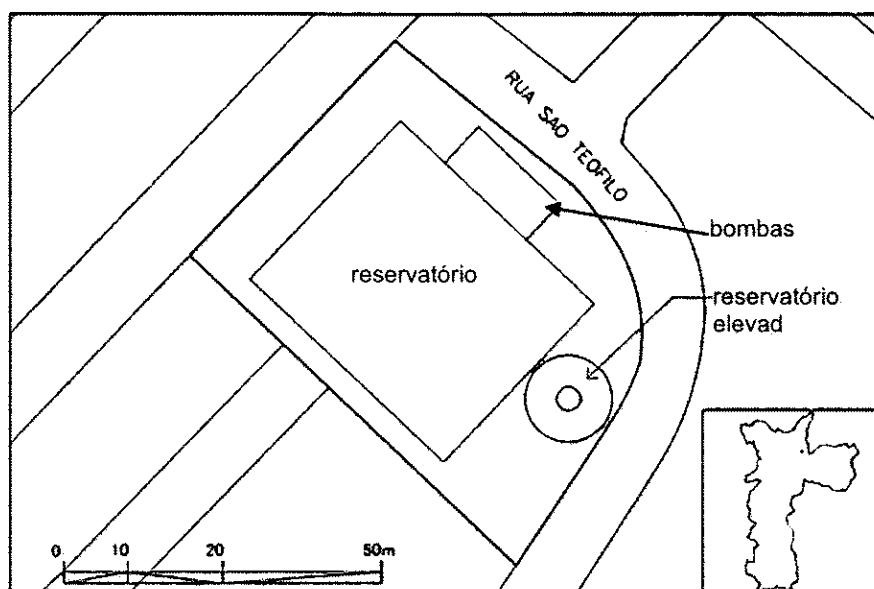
Planta de Estação de Bombeamento de Água Vila Medeiros
